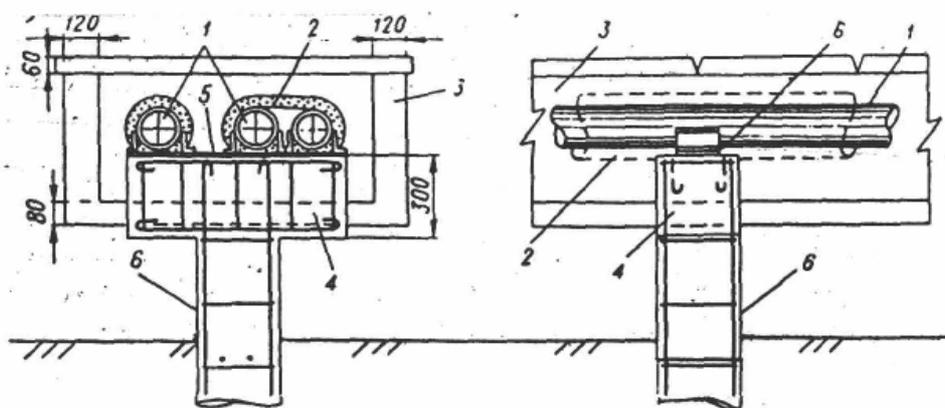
Мертвая опора с одной железобетонной свайей:
